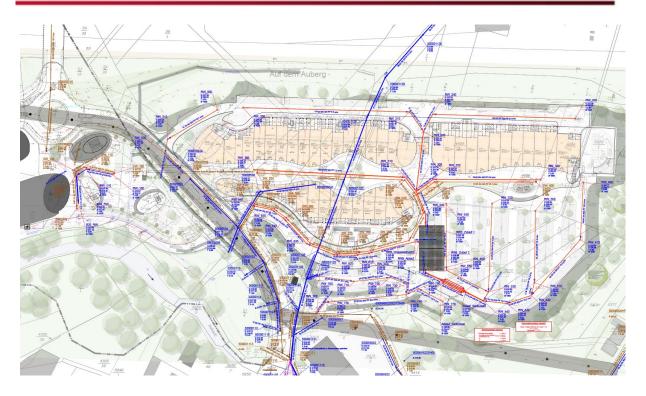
Lageplanausschnitt Planung Entwässerung FOC II, Stadt Montabaur (Auszug Anlagen 3.4)
